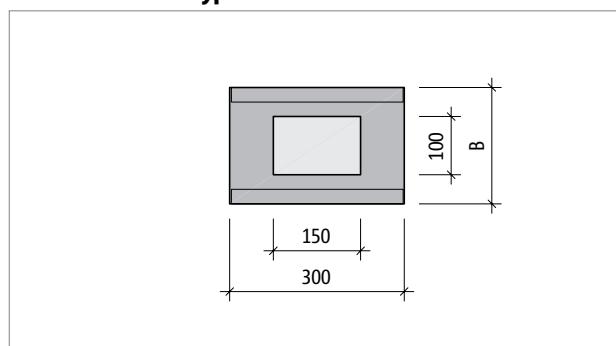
Schöck Sconnex® Typ W-N: Produktgrundriss; Drucklagerfläche
